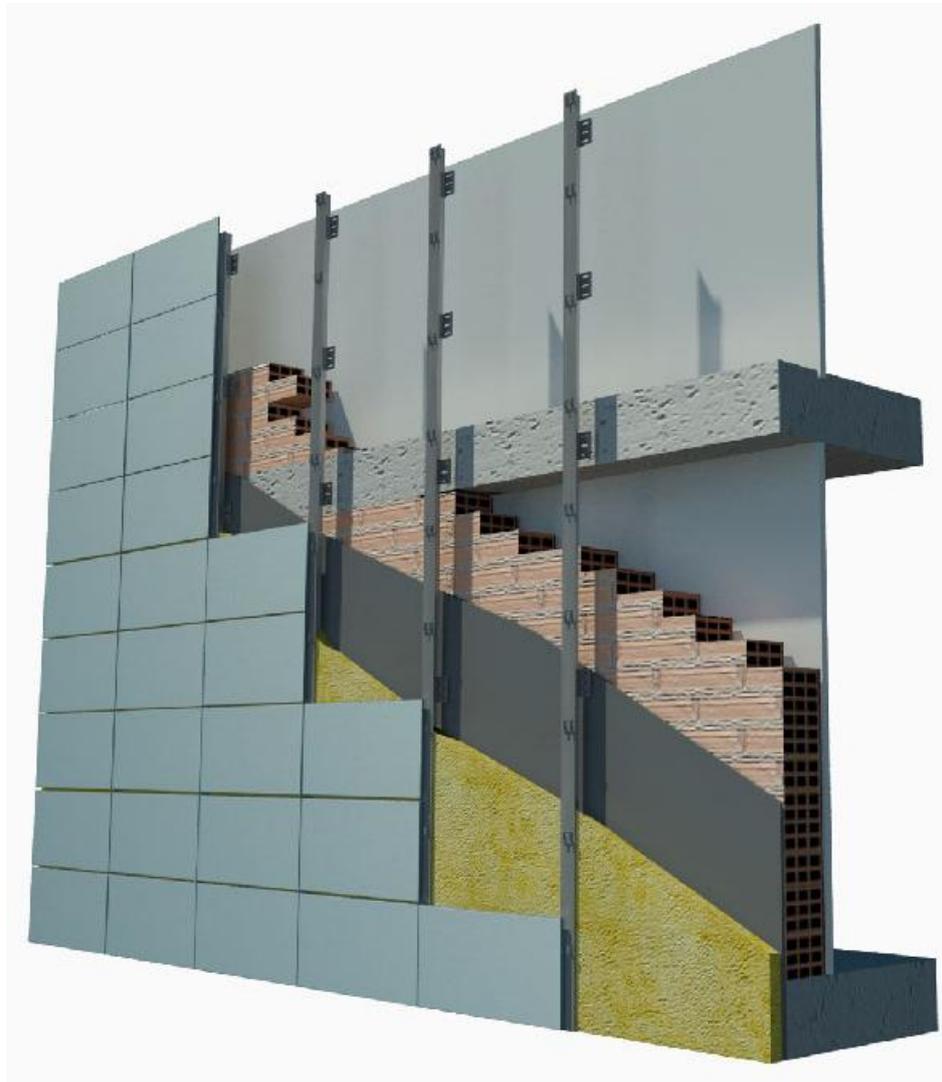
Detalle constructivo fachada ventilada. Empresa Wandegar.
